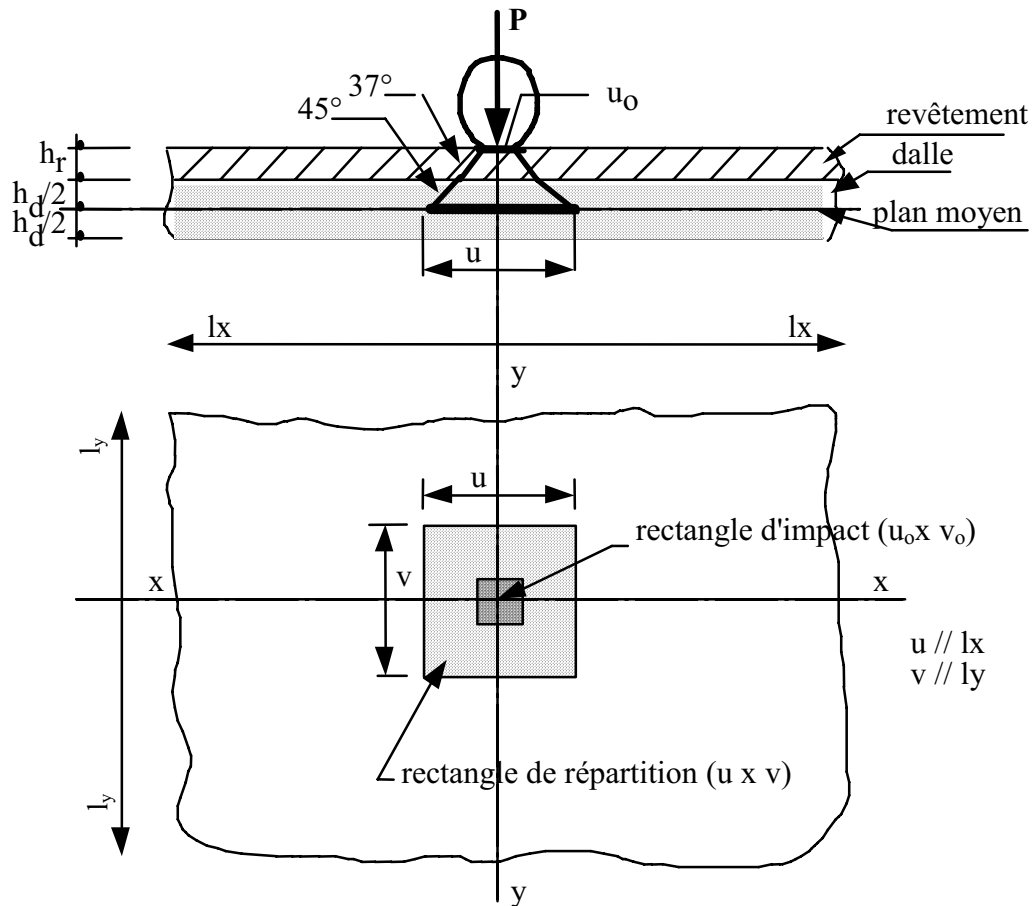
Diffusion d'une charge, P , localisée sur le plan moyen de la dalle.
